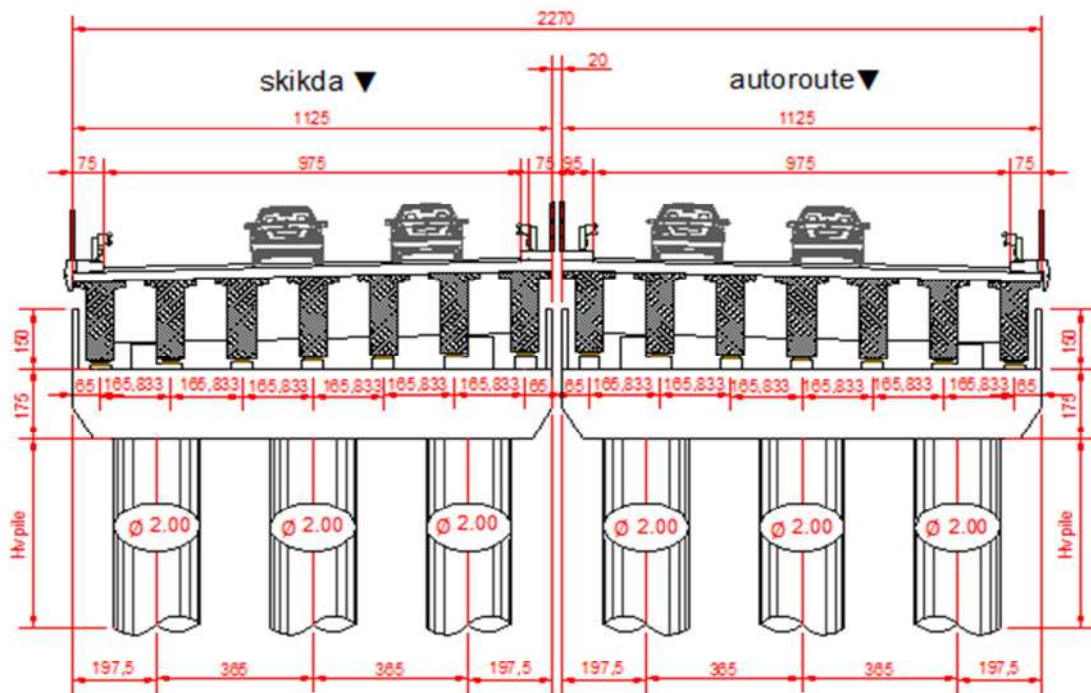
coupe transversale sur pile du pont a poutre précontrainte
